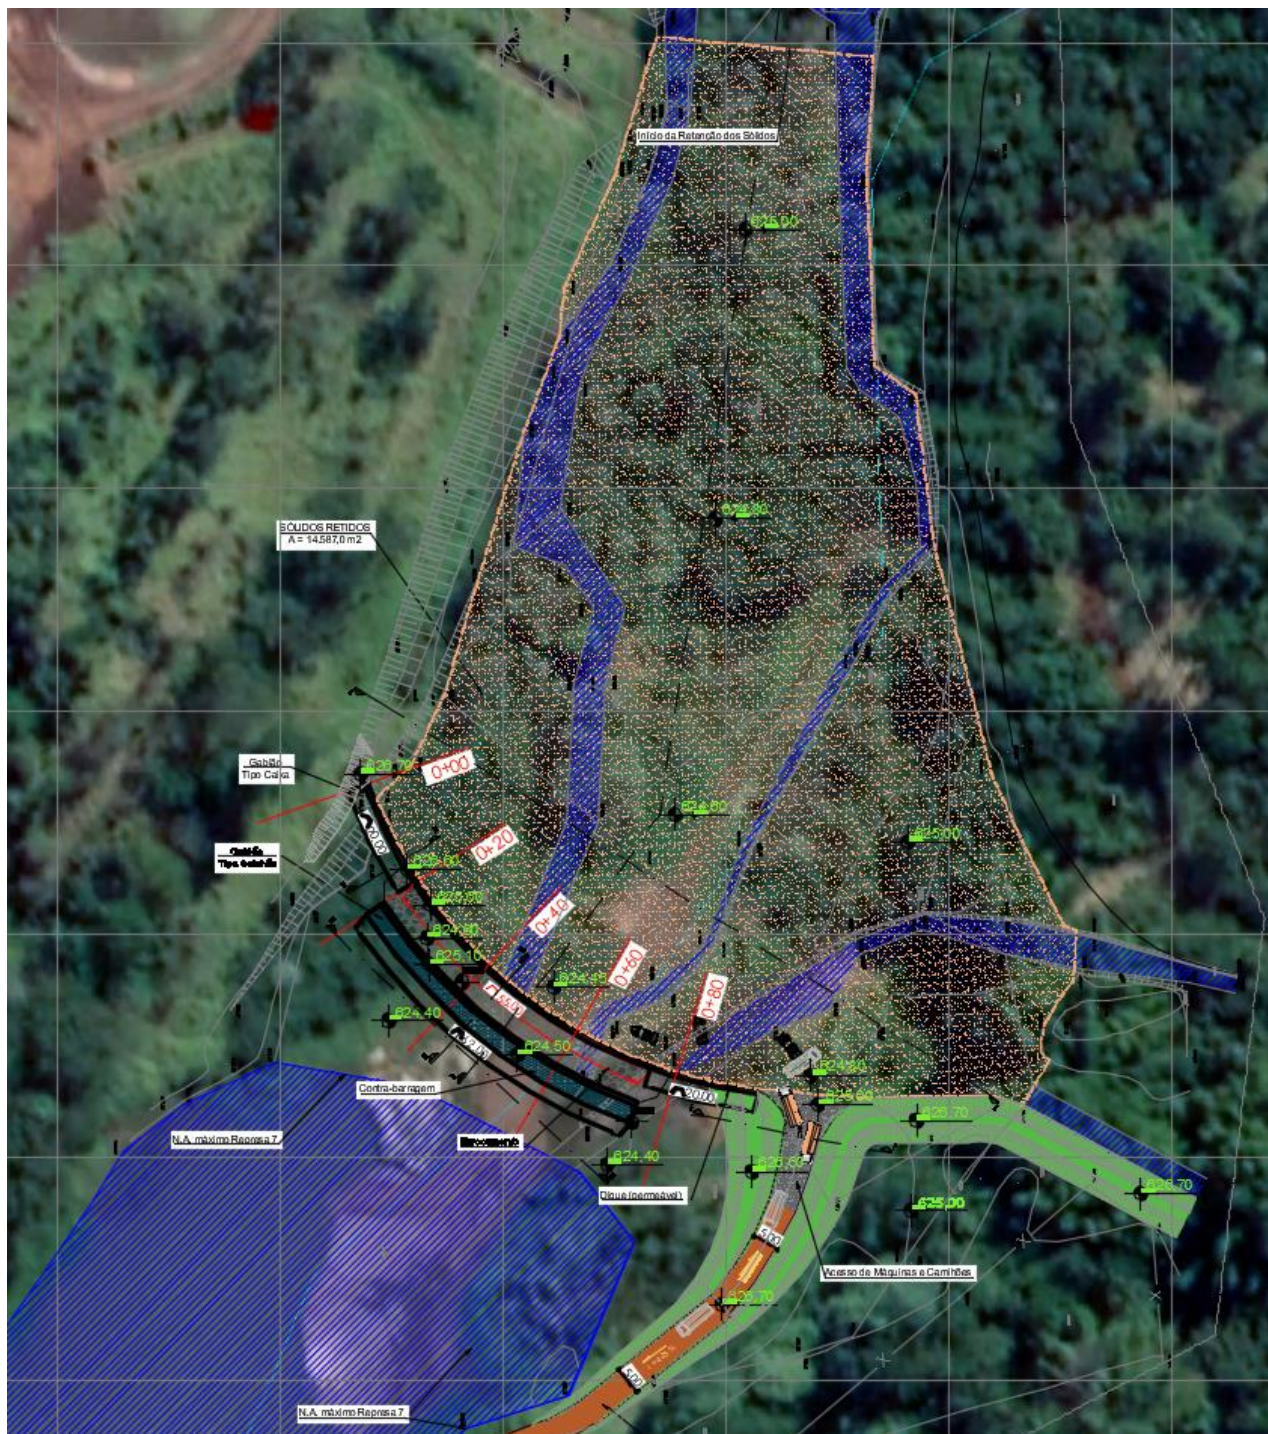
Planta geral do Projeto Executivo da Bacia de Retenção de Sólidos para proteção do reservatório da Represa 7, da Captação do Daae (ver desenhos de projeto).
